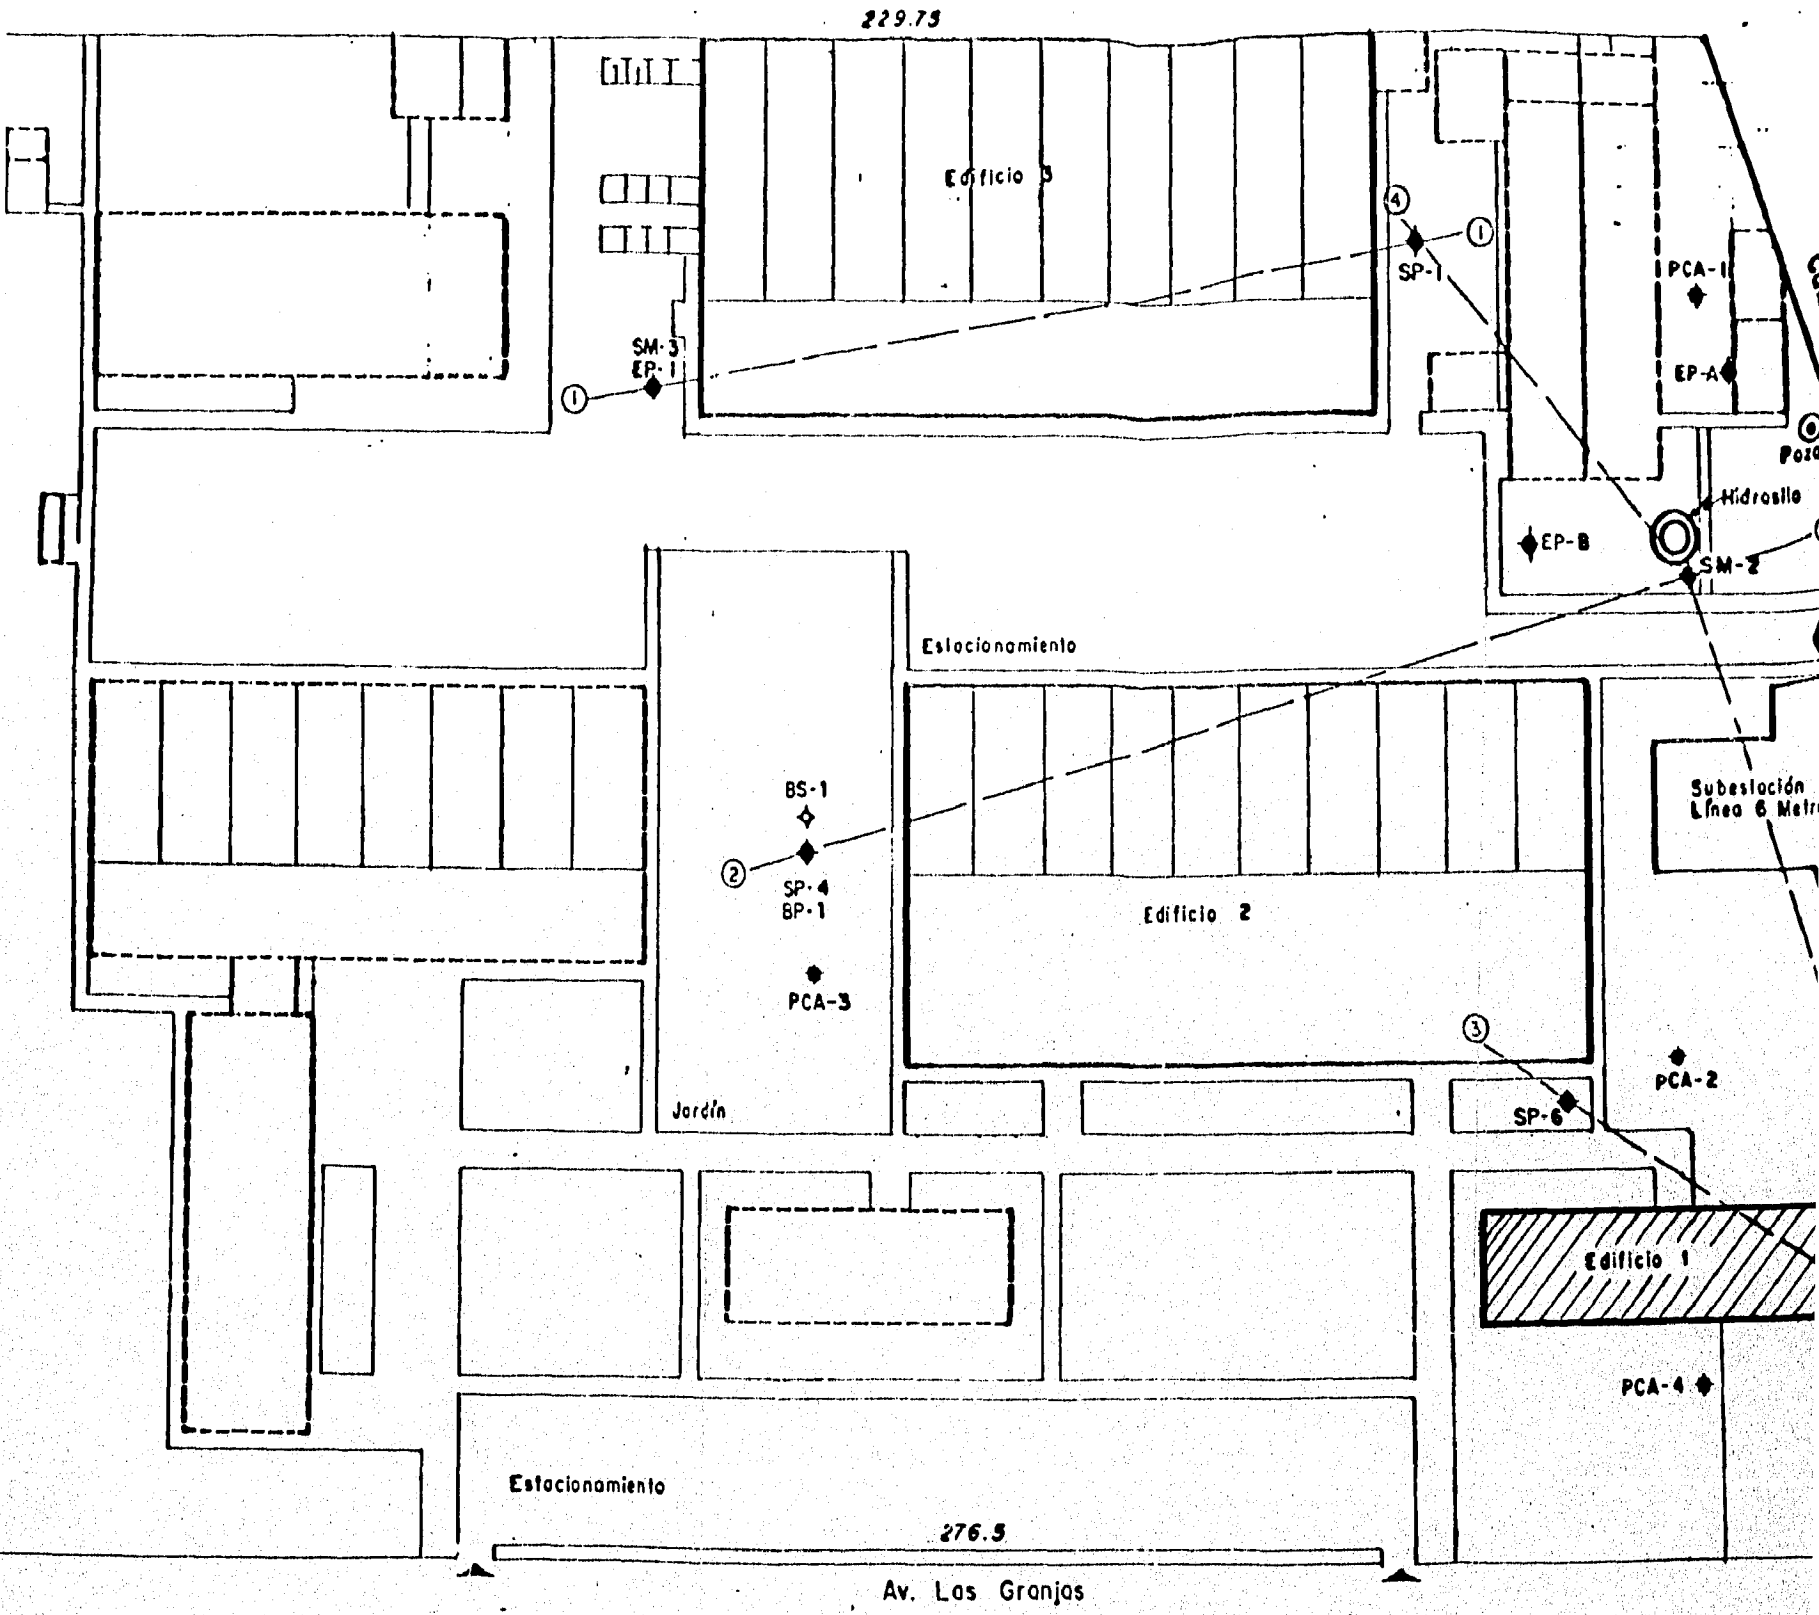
Planta de conjunto y ubicación de sondeos y pozos
